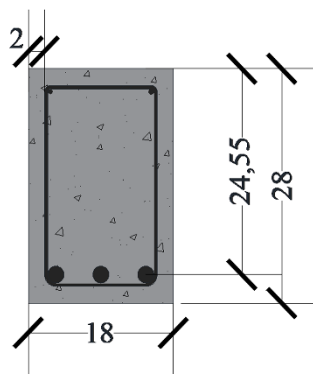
Detalhamento das vigas do grupo A. Cotas em cm.
